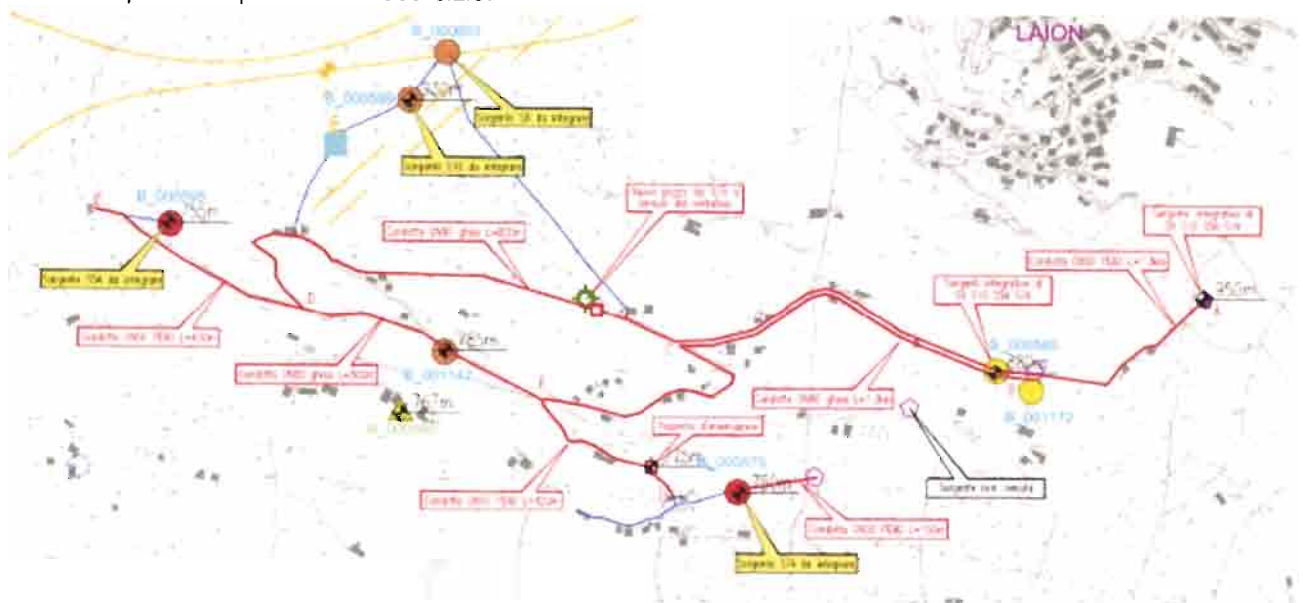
Stralcio planimetrico della soluzione progettuale selezionata
